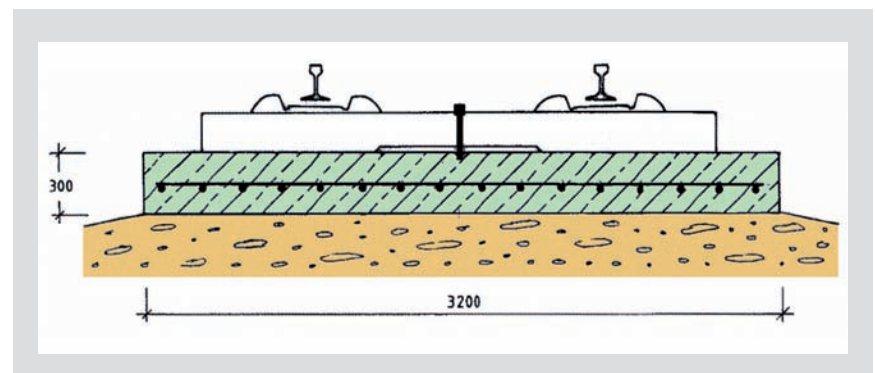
Gleisrost mit durchgehend bewehrter Betontragplatte mit gesteuerter Rissbildung auf ToB [15]
